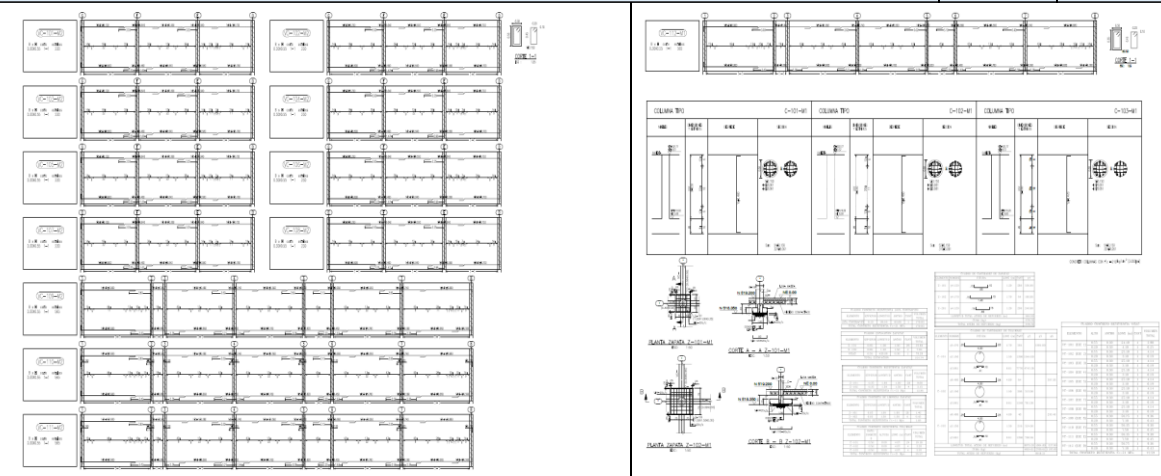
Calculo de cantidad de concreto para vigas de cimentación
